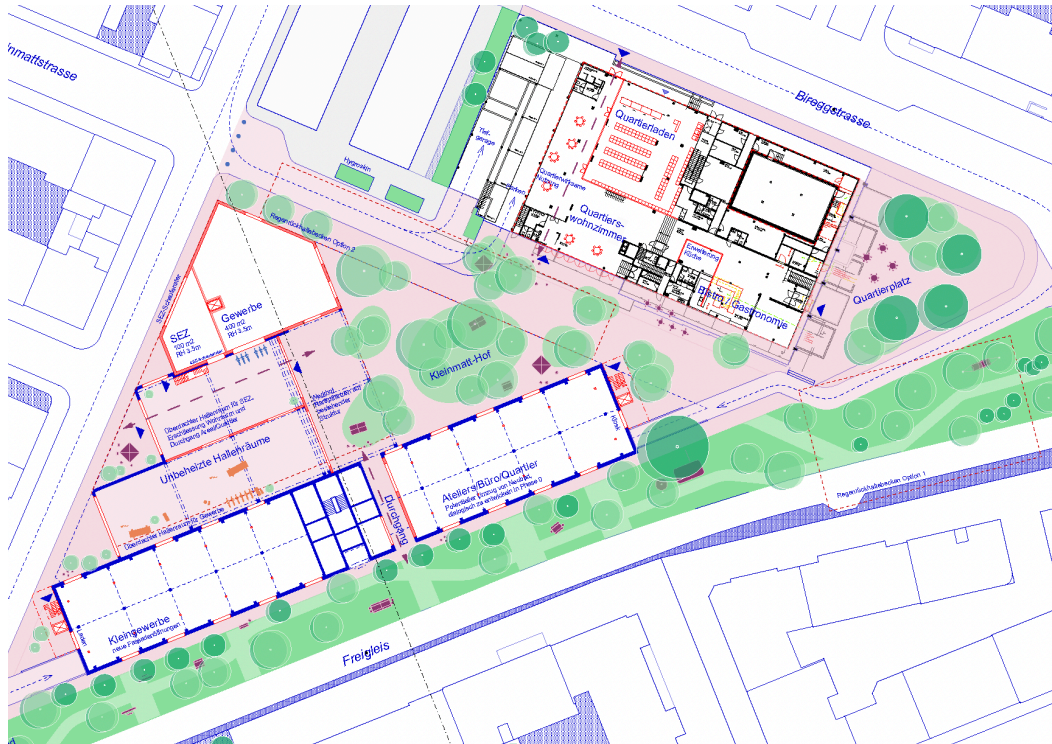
Erdgeschoss und Schnitt der Variante «Kleinmatt-Hof» (Quelle: Denkstatt särl + Baubüro in situ)
